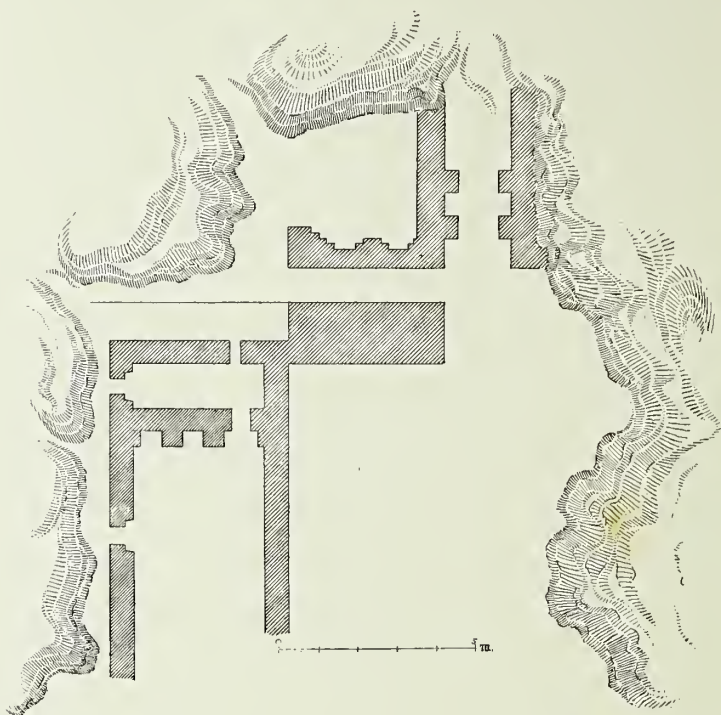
CÁMARAS DE UN PALACIO DESCUBIERTO EN ABU SHAREIN: PLANTA (SEGÚN TAYLOR)
